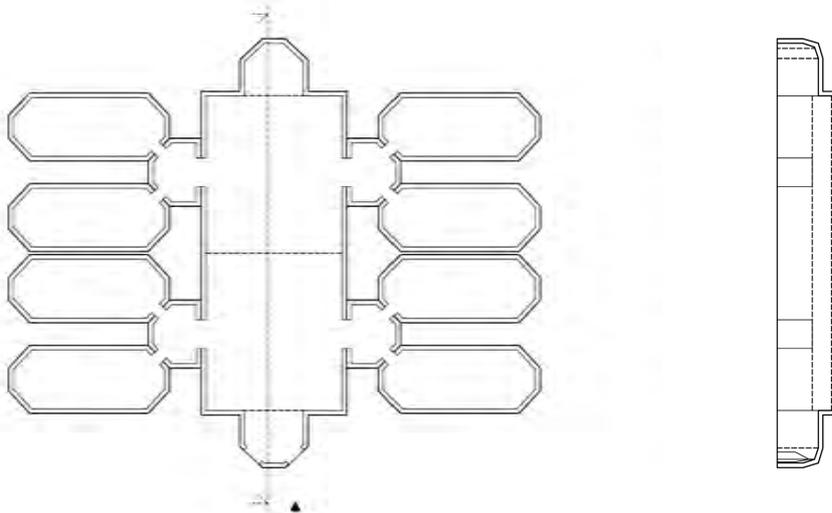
DRASH-Shelteranlage mit JS- und XB-Sheltern, Grundriss und Querschnitt. Grundfläche 511 m². Maßstab 1:500. Eigene Darstellung.
